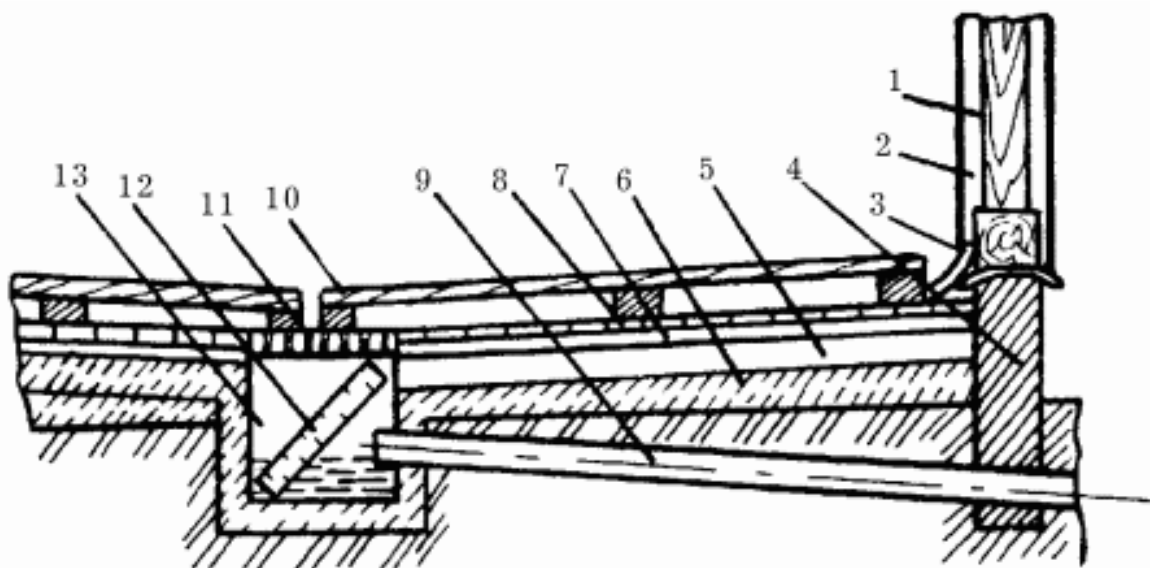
Конструкция бетонного пола: 1 – внутренняя обшивка каркасной стены; 2 – пароизоляция стены; 3 – гидроизоляция; 4 – фундамент; 4 – щебеночно-гравийная подсыпка; 6 – бетон с теплоизолирующим наполнителем; 7 – выравнивающая цементная стяжка; 8 – покрытие из керамических плиток; 9 – водосливная труба; 10 – деревянная решетка; 11 – водосточная решетка; 12 – щит гидрозатвора; 13 – приямок.
